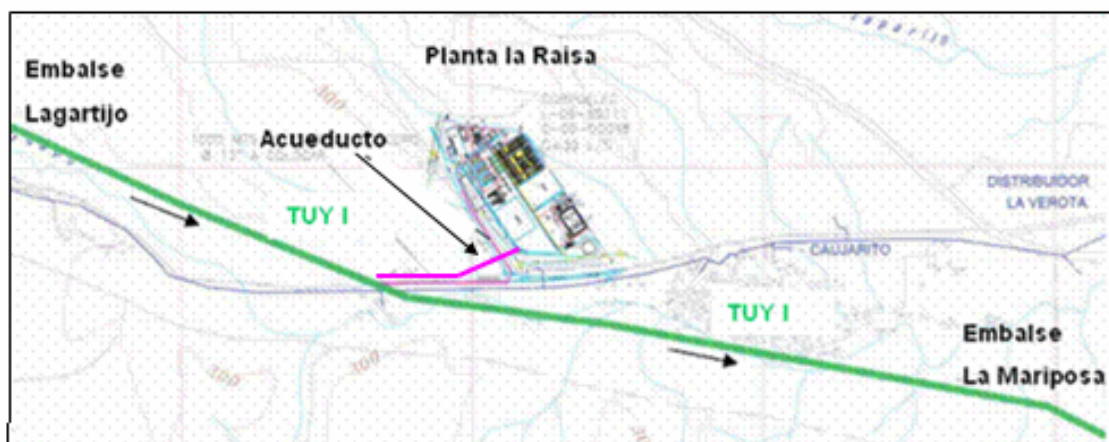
Esquema El Acueducto 48" y LA ADUCCION para la Planta de Generación la Raisa
